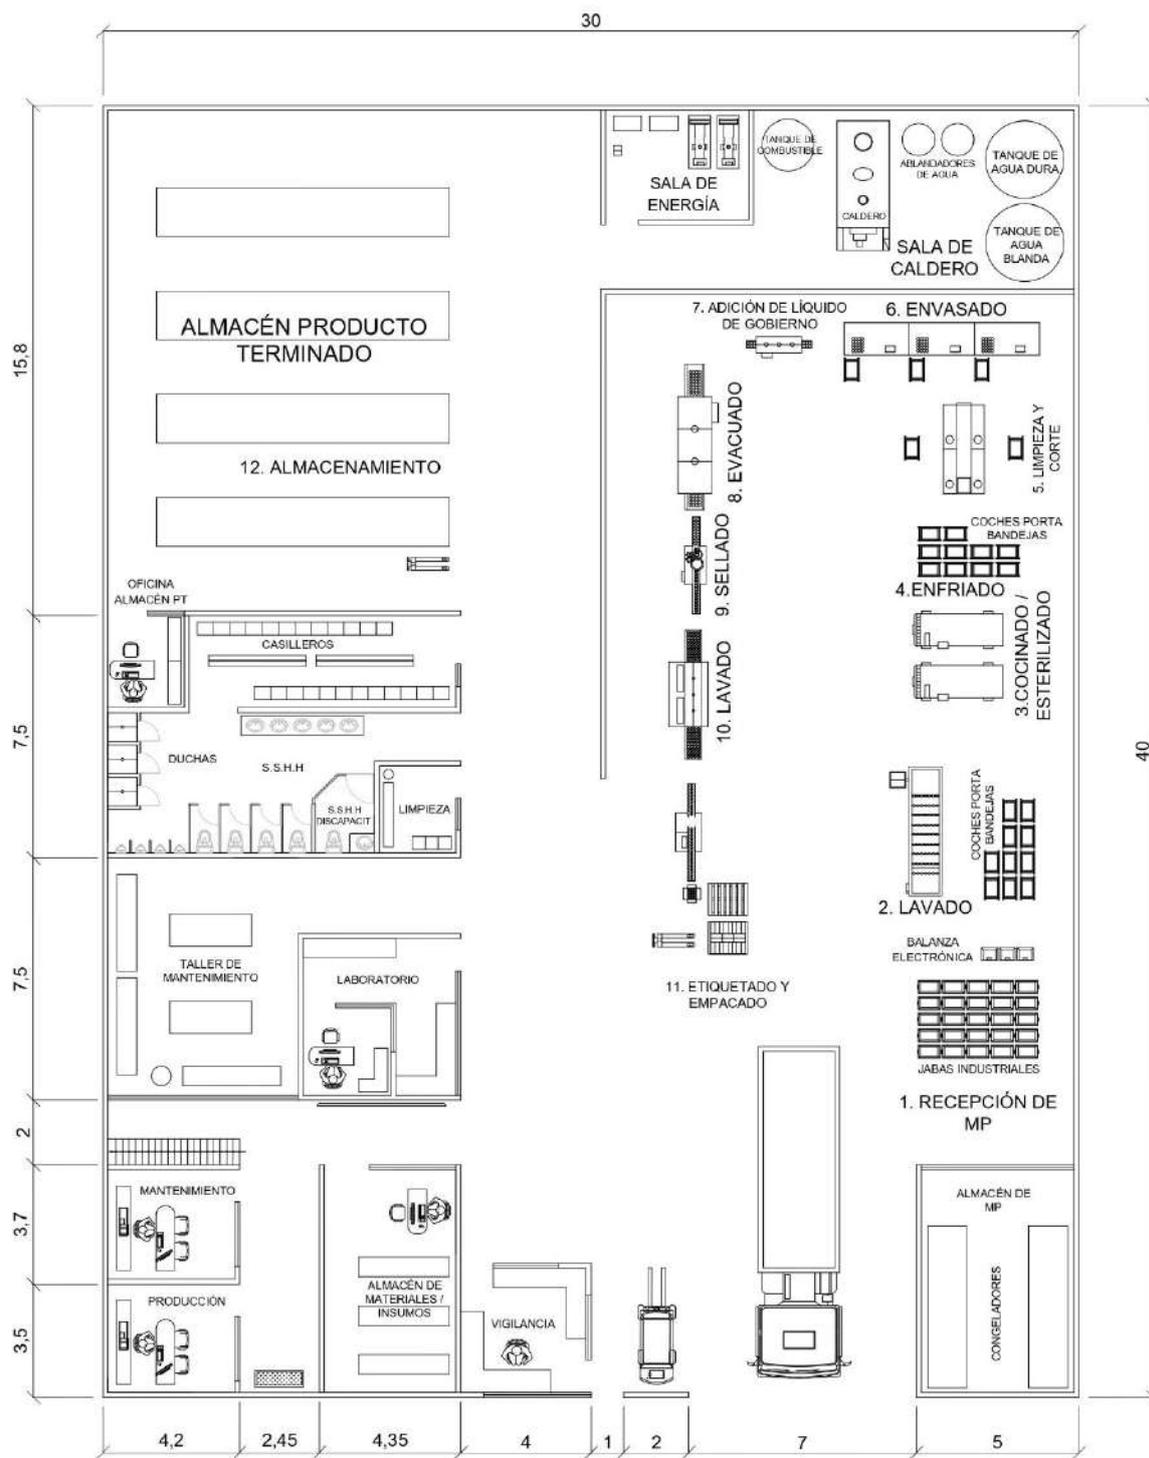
Vista de planta propuesta de la fábrica de conservas de pescado (primer piso).
